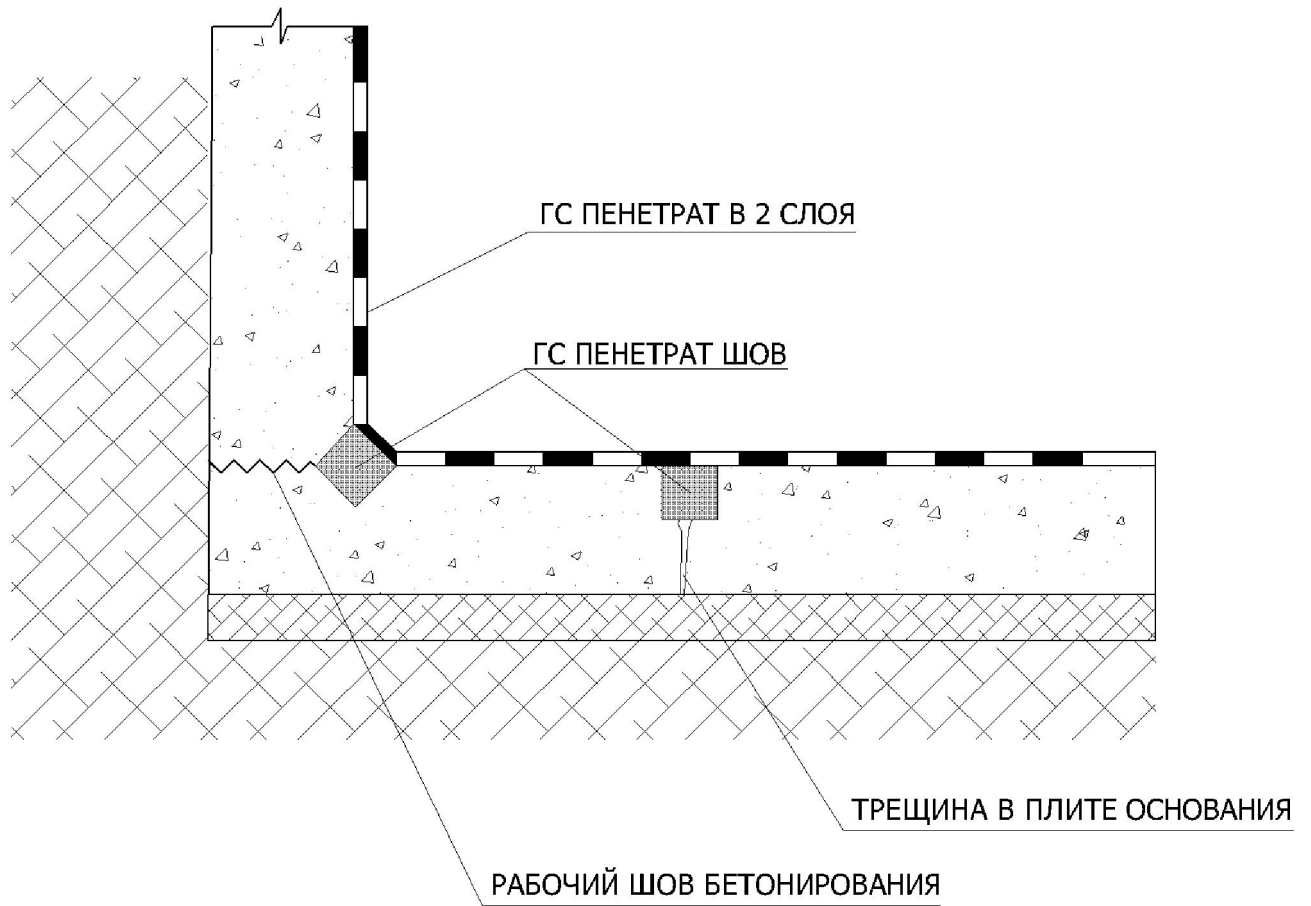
Устройство гидроизоляции монолитного бетонного пола
